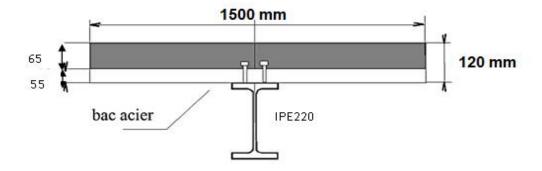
La largeur participante de la dalle en béton (beff)
